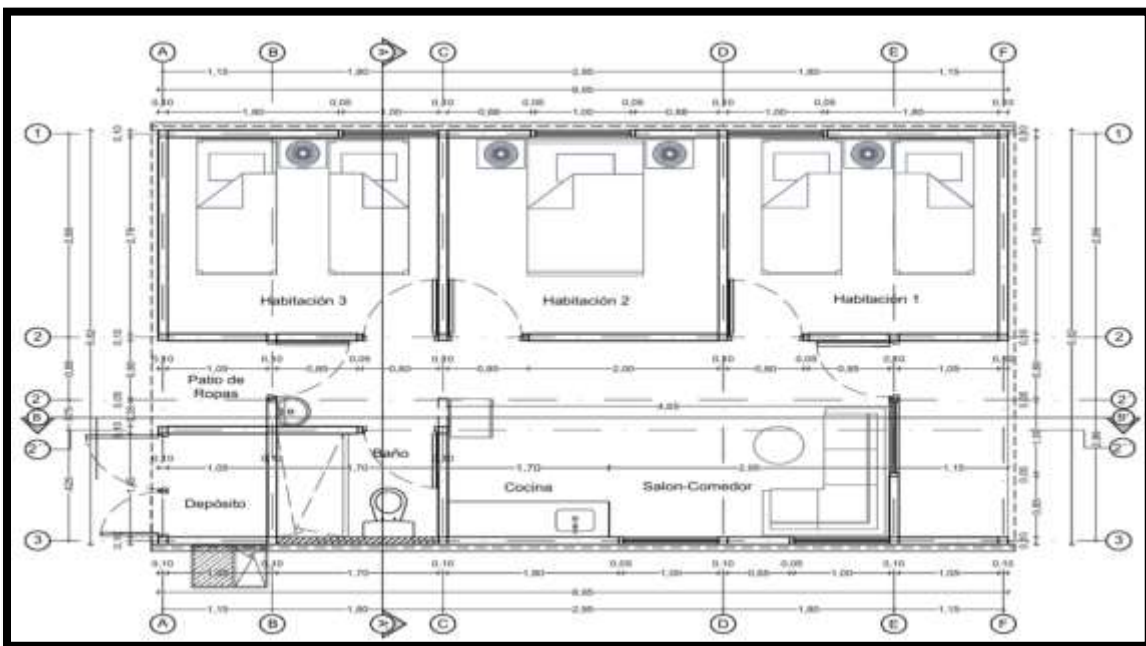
Plano arquitectónico, Vivienda de interés social rural nueva.
